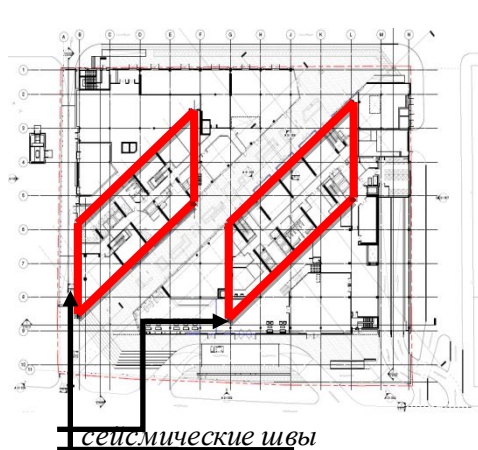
План подвального этажа. Красными линиями отмечены сейсмические горизонтальные разделяющие швы на плане и в конструкциях по первому варианту проекта
